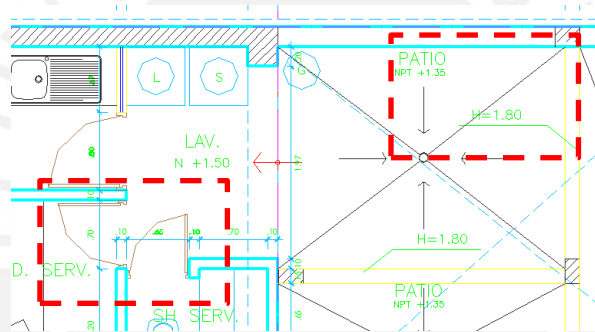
Planta del Primer Nivel – “Cotas”
